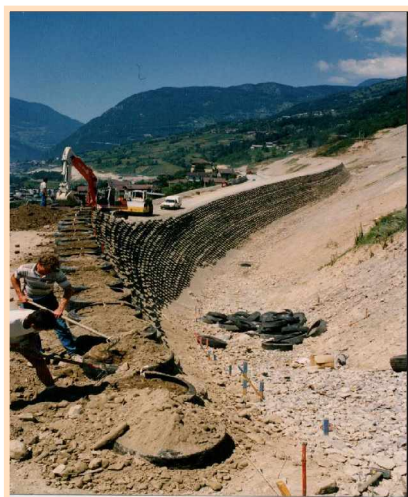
Mur de protection contre les chutes de blocs et paravalanches
